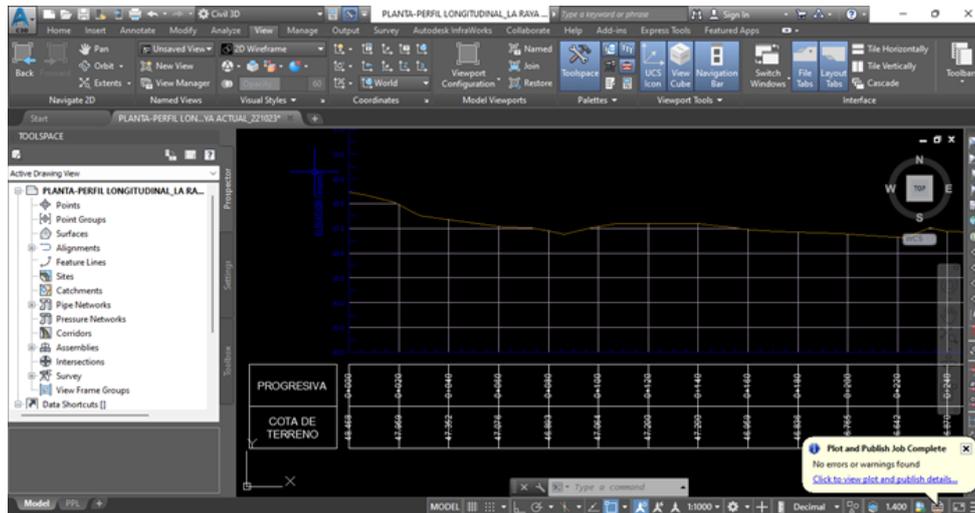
Trazo de Perfiles longitudinales y Secciones Transversales
